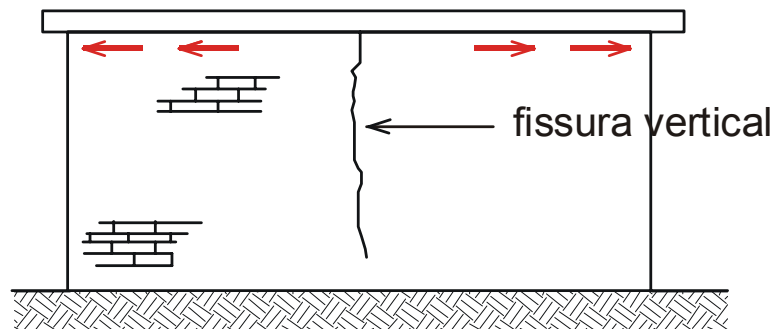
fissura vertical por movimentação térmica da laje (DUARTE, 1998)
